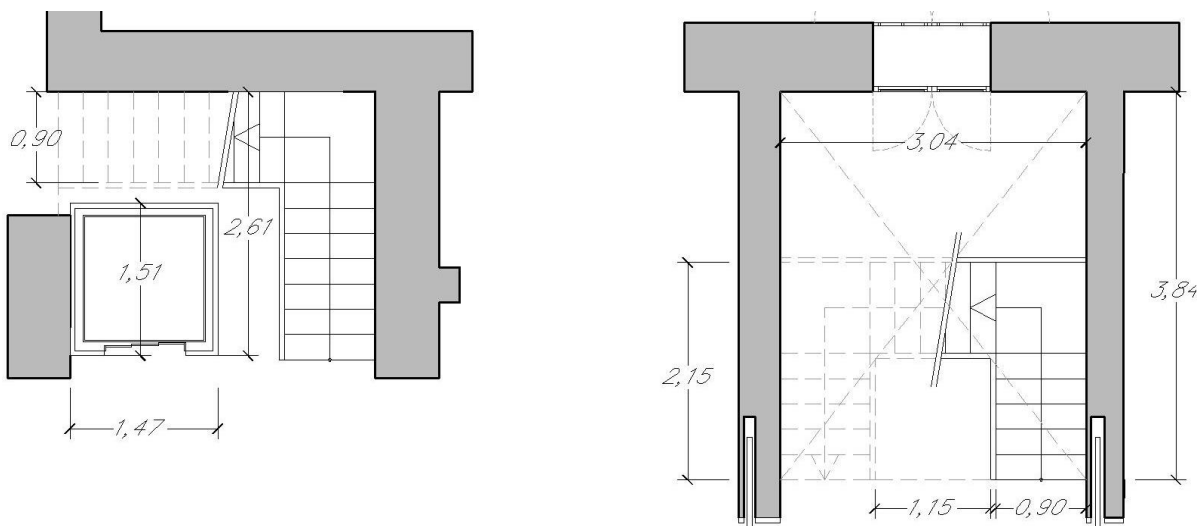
Plano escaleras (Fuente: Propio)
